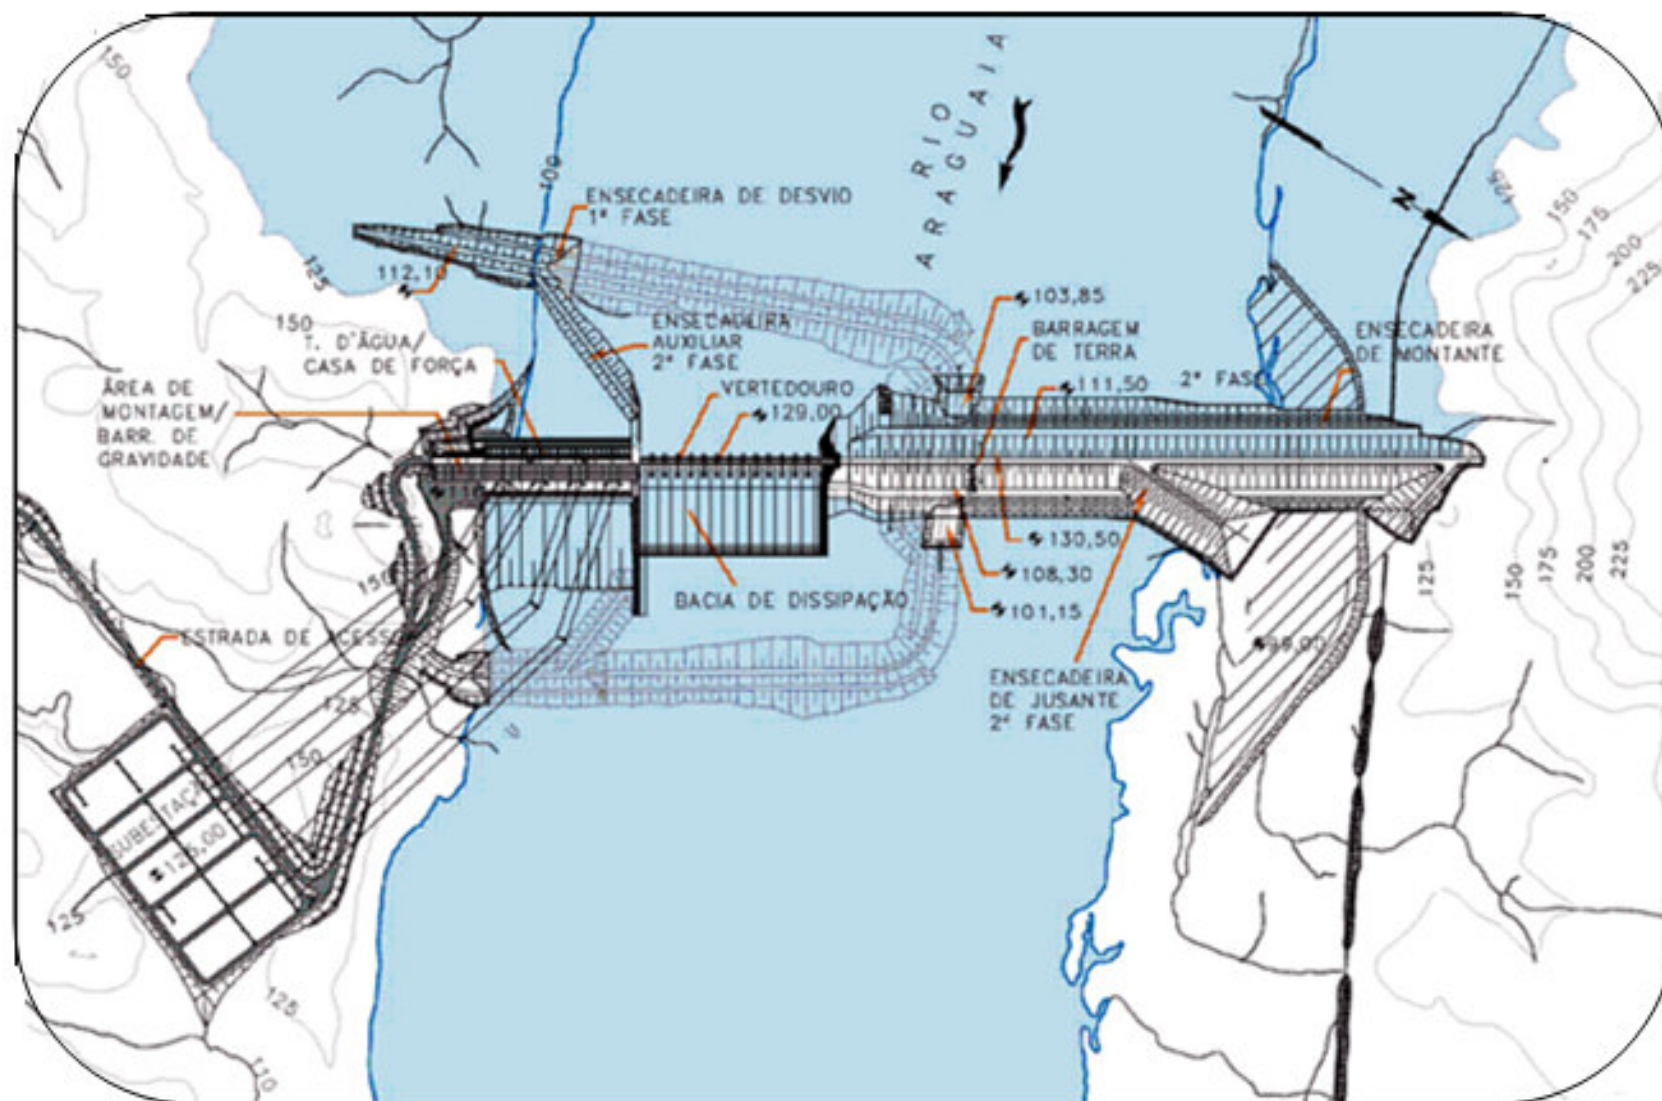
Arranjo geral do AHE Santa Isabel.
